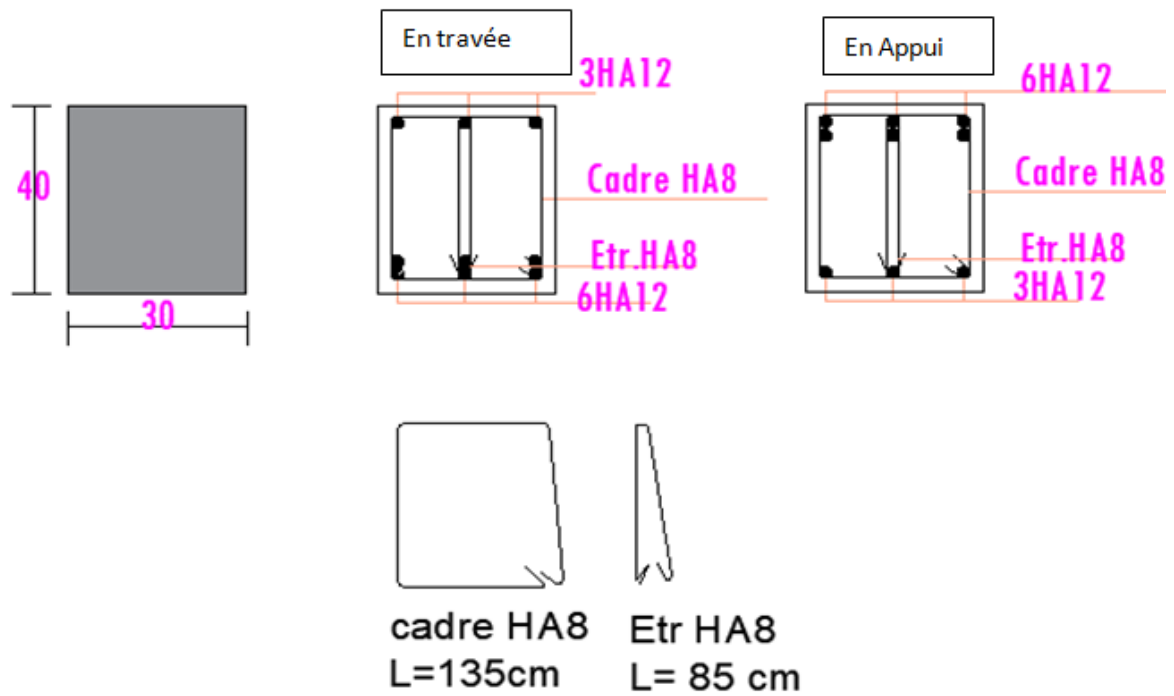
schéma ferrailage de poutre secondaire type 01
